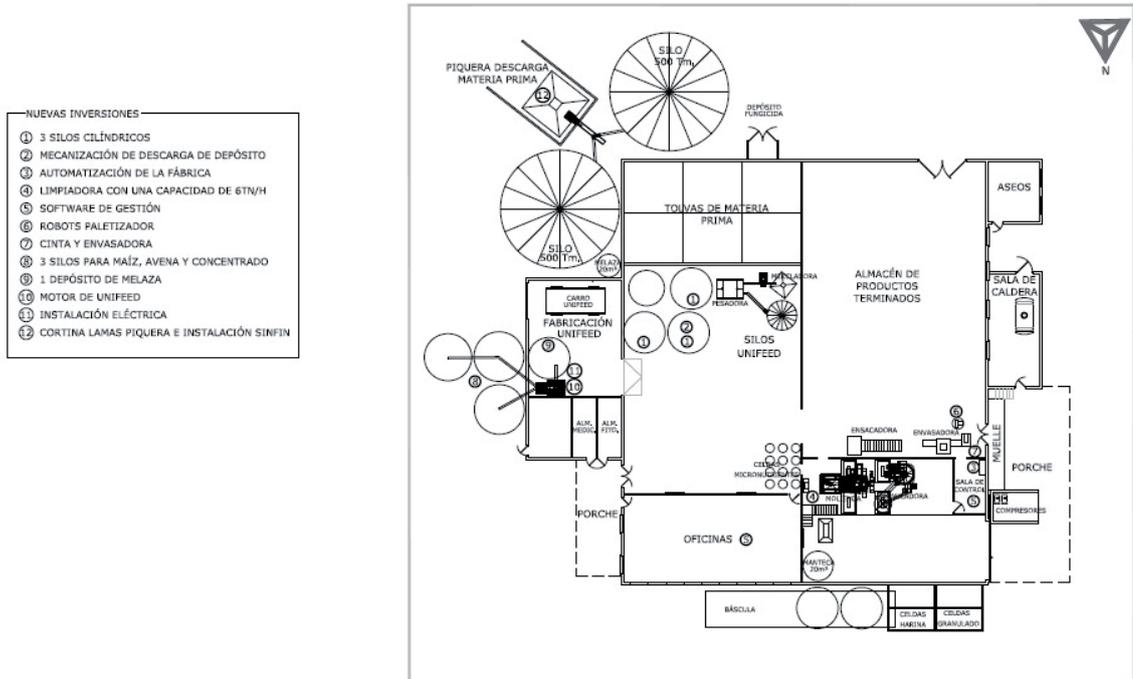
Planta general de la fábrica de piensos (estado futuro).
